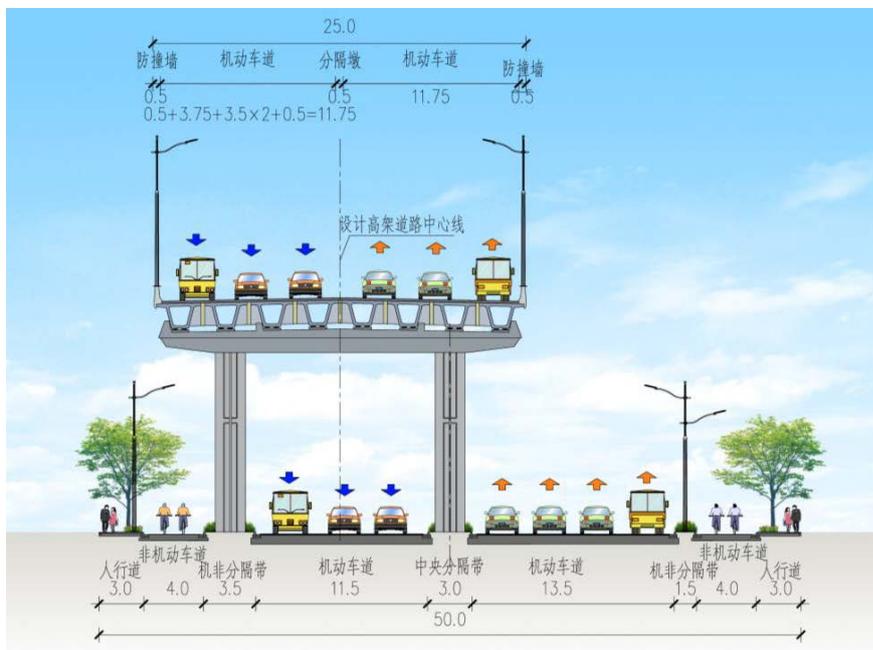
标准横断面布置——茶园路衔接段高架快速路横断面图
